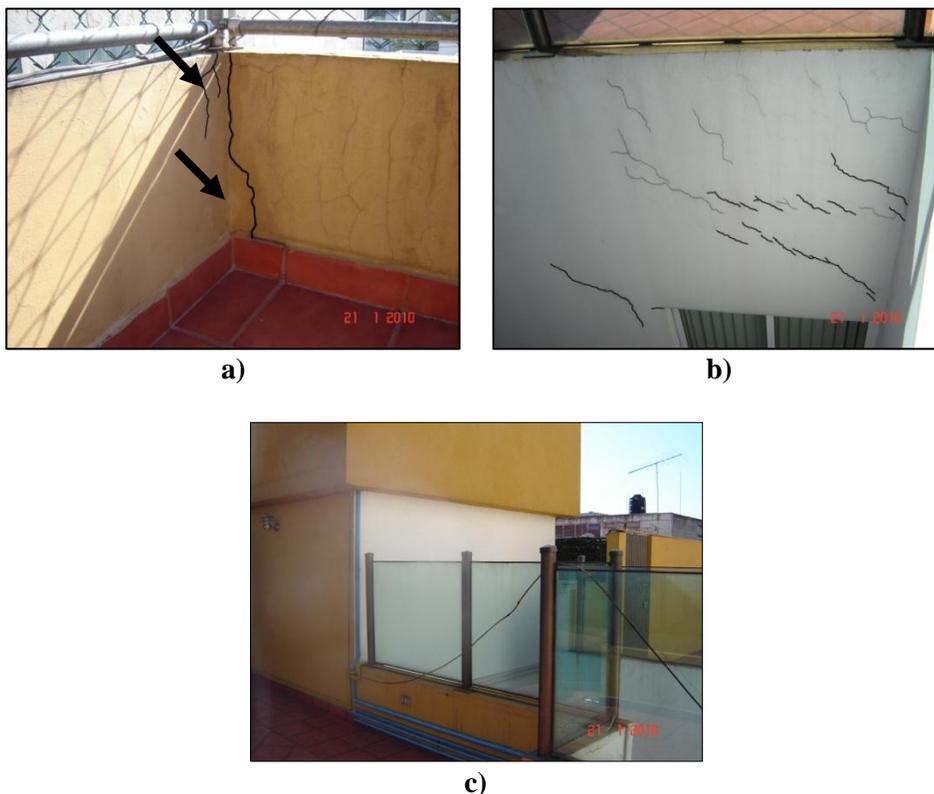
Pretil: a) grietas en pretil en esquina, b) grietas en pretil, y c) barandales de vidrio
